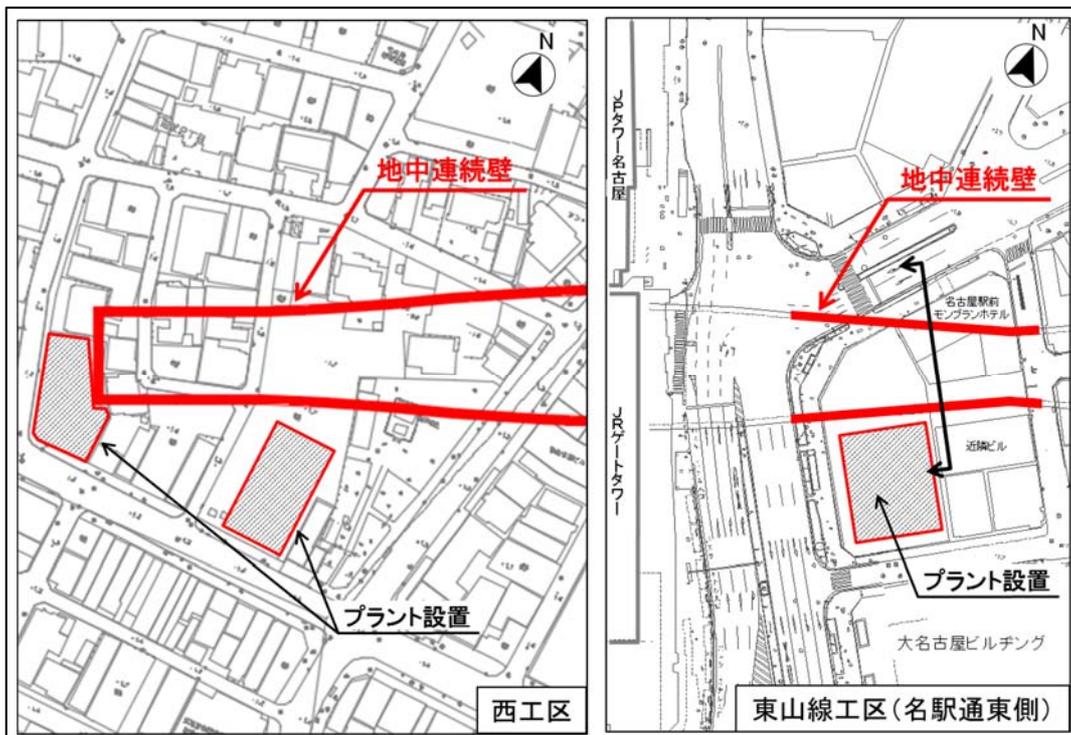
(3) 地中連続壁工の施工位置及び手順（平面図）
